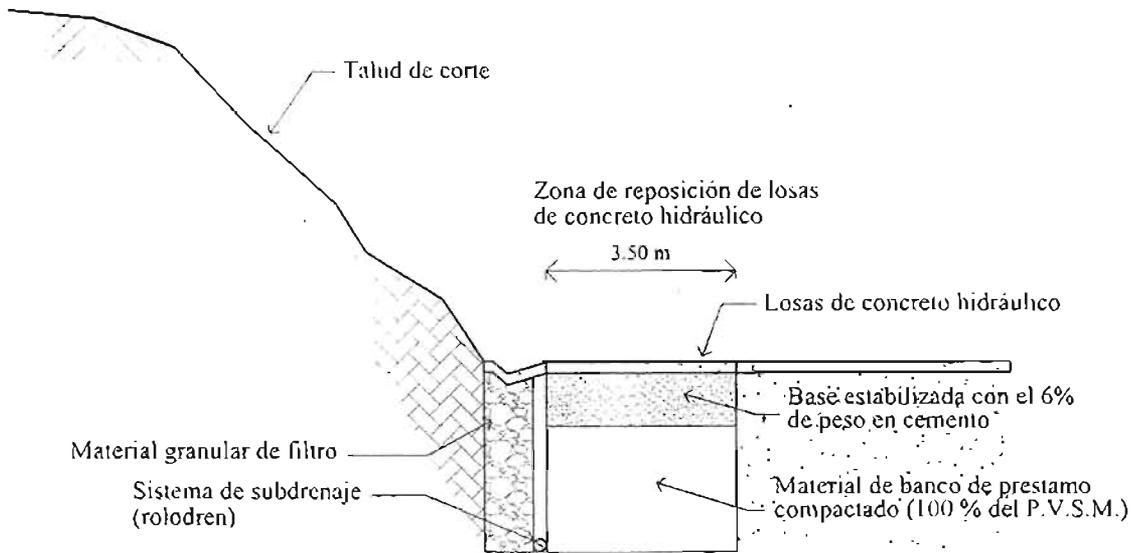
PROYECTO DE REPOSICIÓN DE LOSAS DE CONCRETO HIDRÁULICO Y DE BASE CON MATERIAL ESTABILIZADO CON CEMENTO. AUTOPISTA MÉXICO - TUXPAN.
